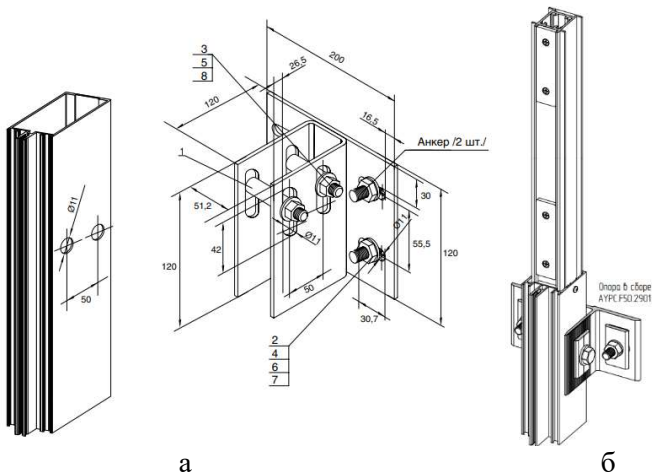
Узлы крепления светопрозрачных фасадов:
